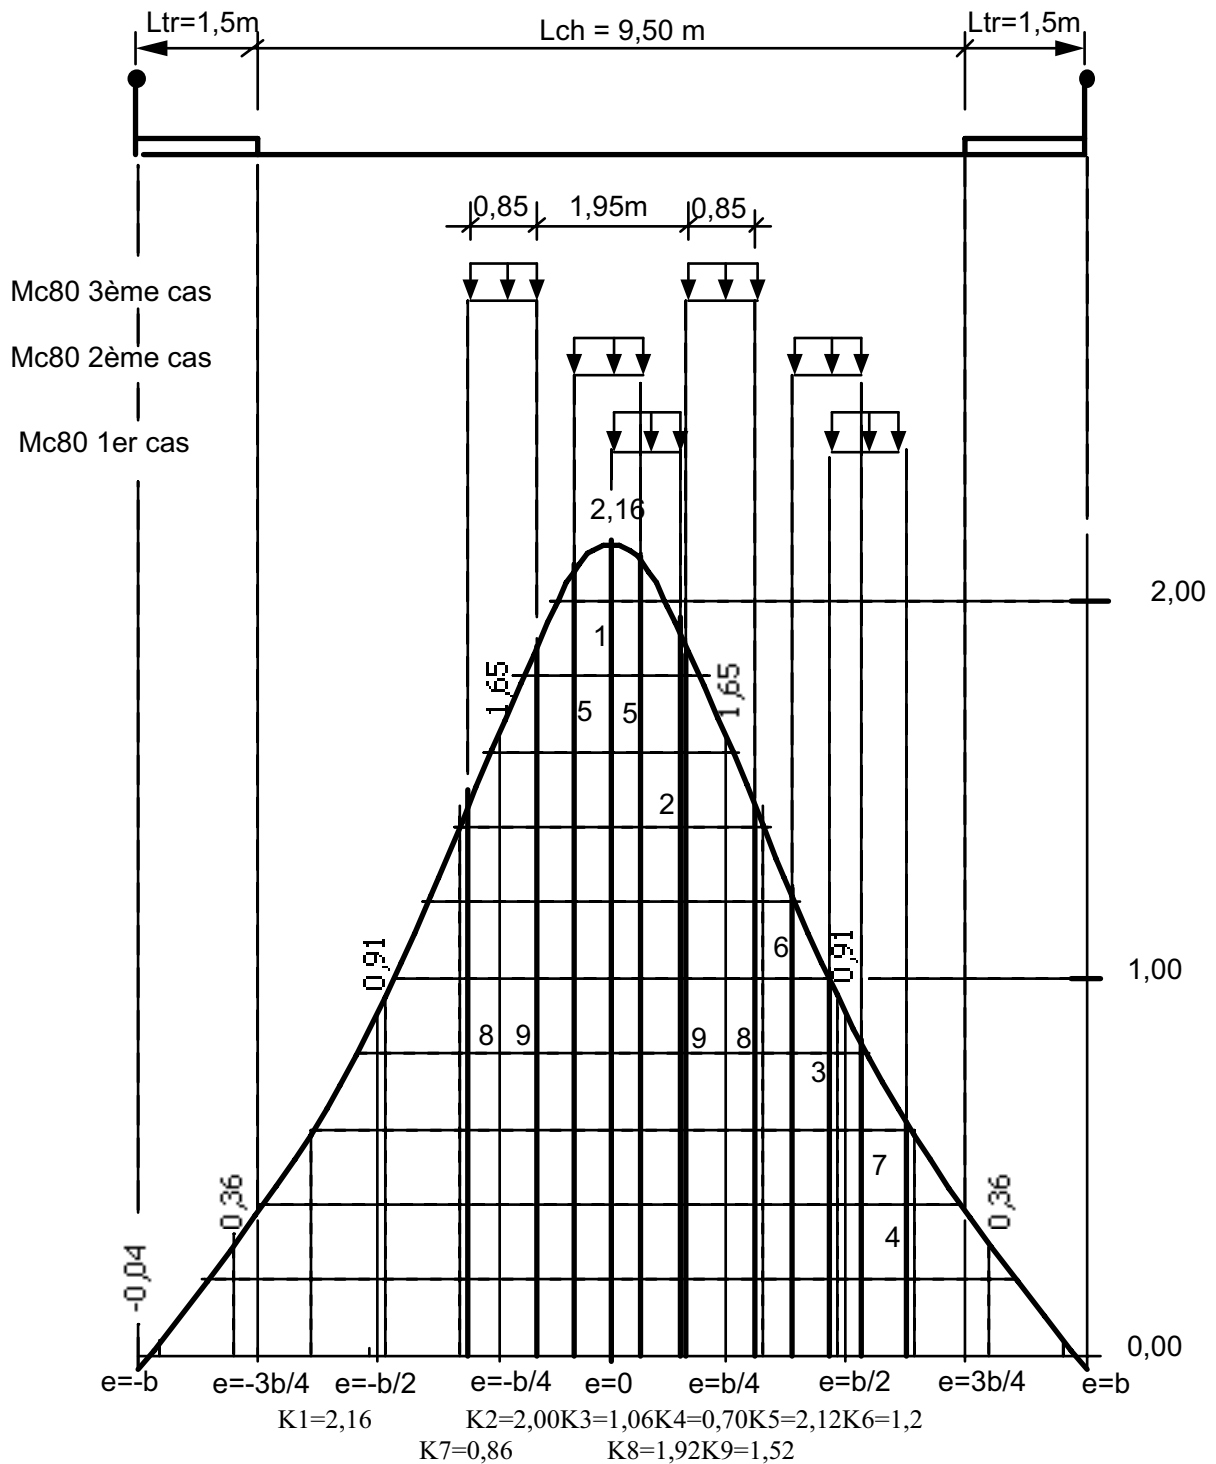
Chargement par Mc80 sur la Li de la poutre centrale (N°3)
